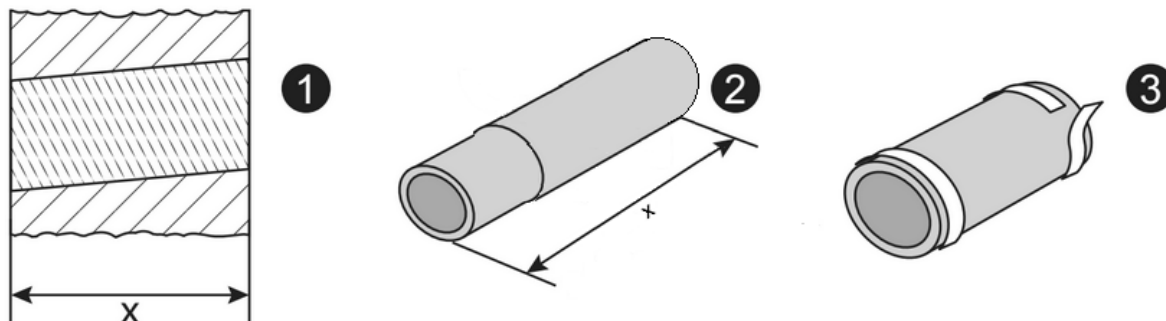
Подготовка вентиляционной трубы к установке в канал воздуховода.
